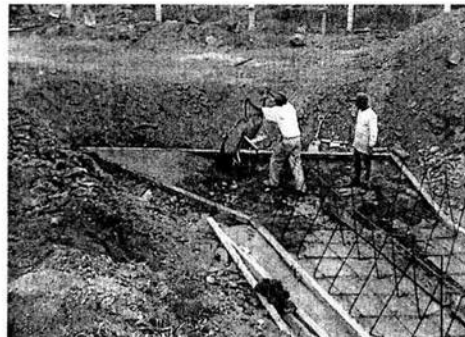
Colado de plantilla de la alcantarilla localizada en el km 138+367.5
